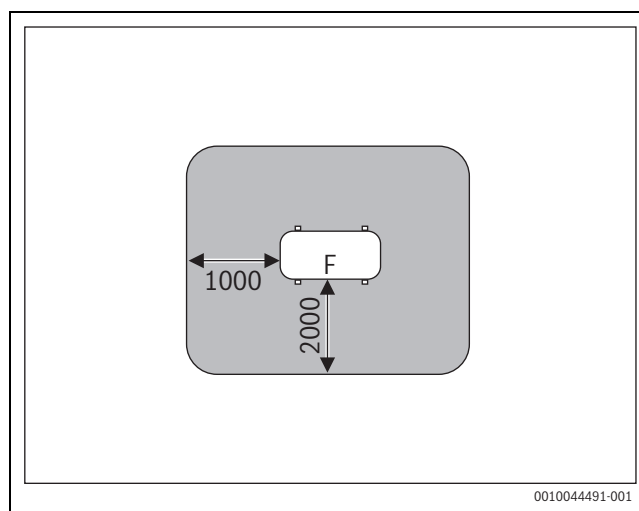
Zona di sicurezza per installazione a pavimento sul terreno di pertinenza o sul tetto - misure in mm
